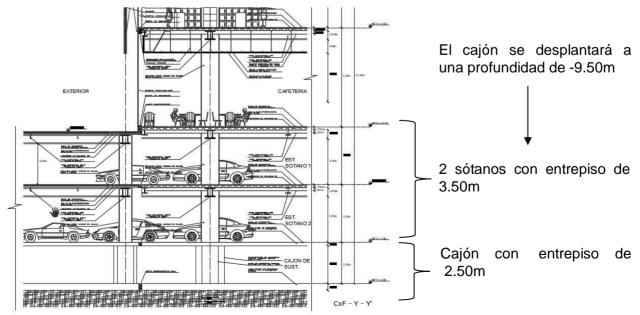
Corte por fachada del proyecto. Elaboración propia.
